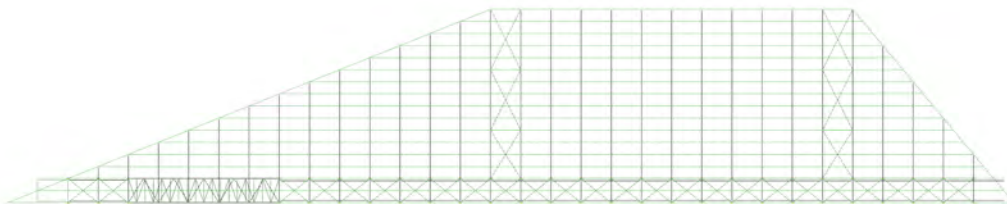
Schema dei controventi di falda in una vista di pianta.
